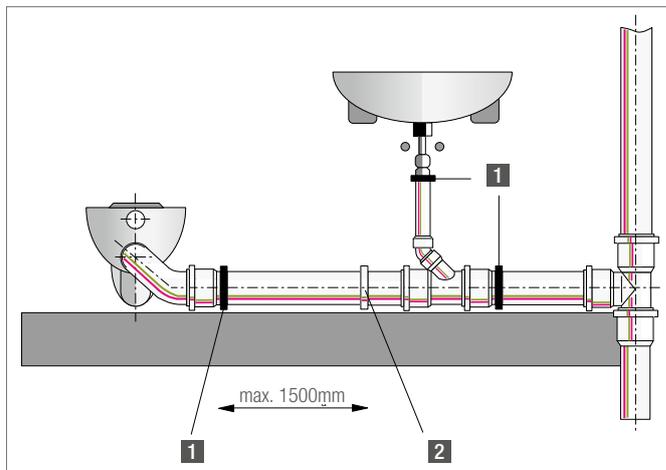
Esquema de fijación de un tramo de tubería horizontal
